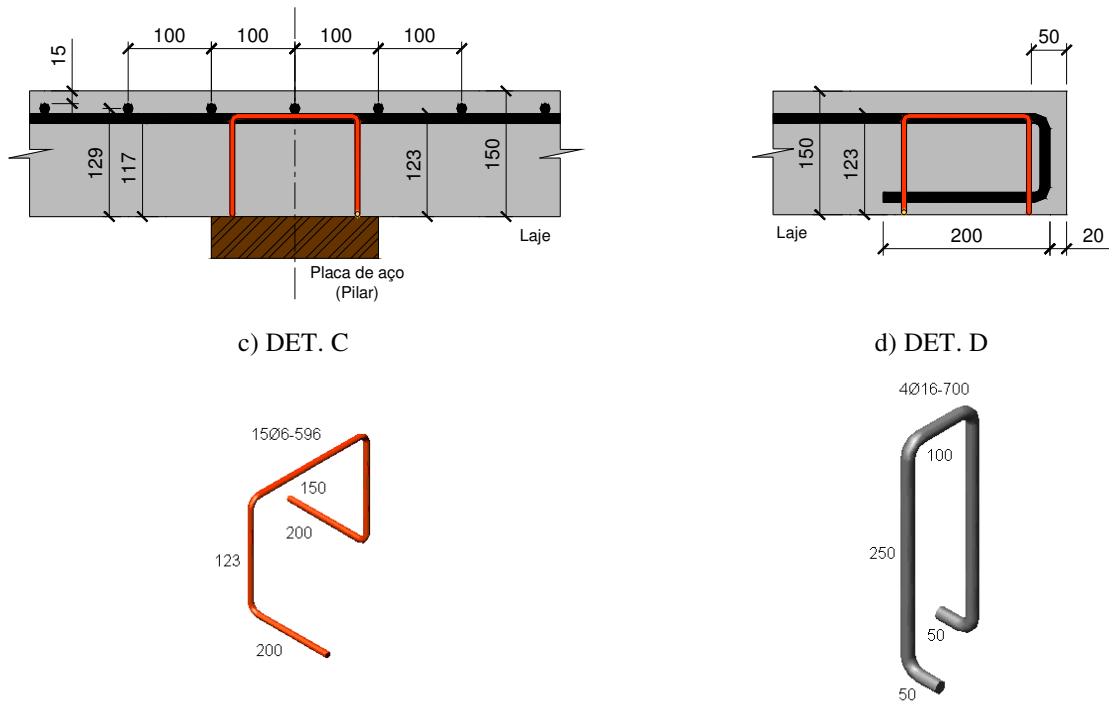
Detalhe das armaduras das lajes de CRFA – Cortes
